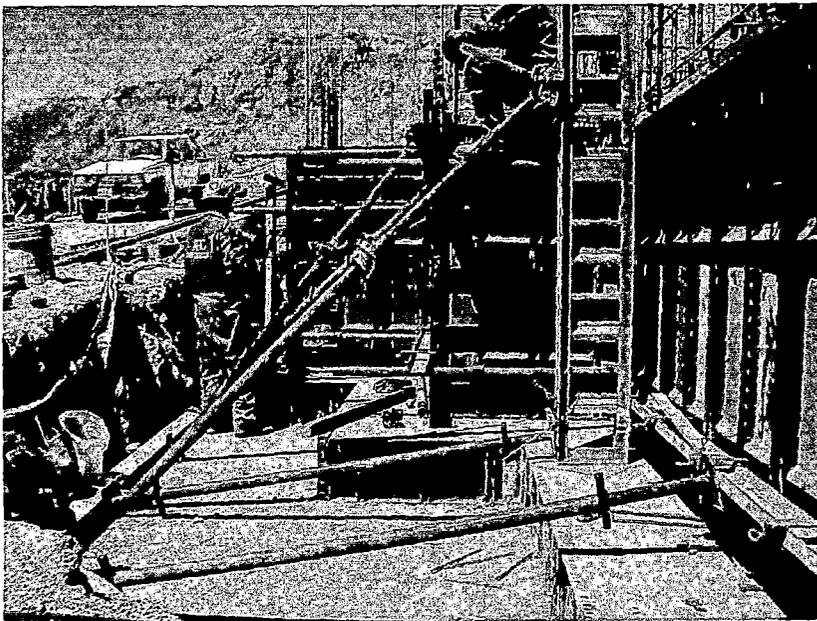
SE OBSERVA EL VACIADO DE UNA CAPA DE LA BASE Y EL HABILITADO Y COLOCADO DEL ENCOFRADO METALICOS (UNI SPAN) PARA EL VACIADO DE LA BASE WINCHE.
